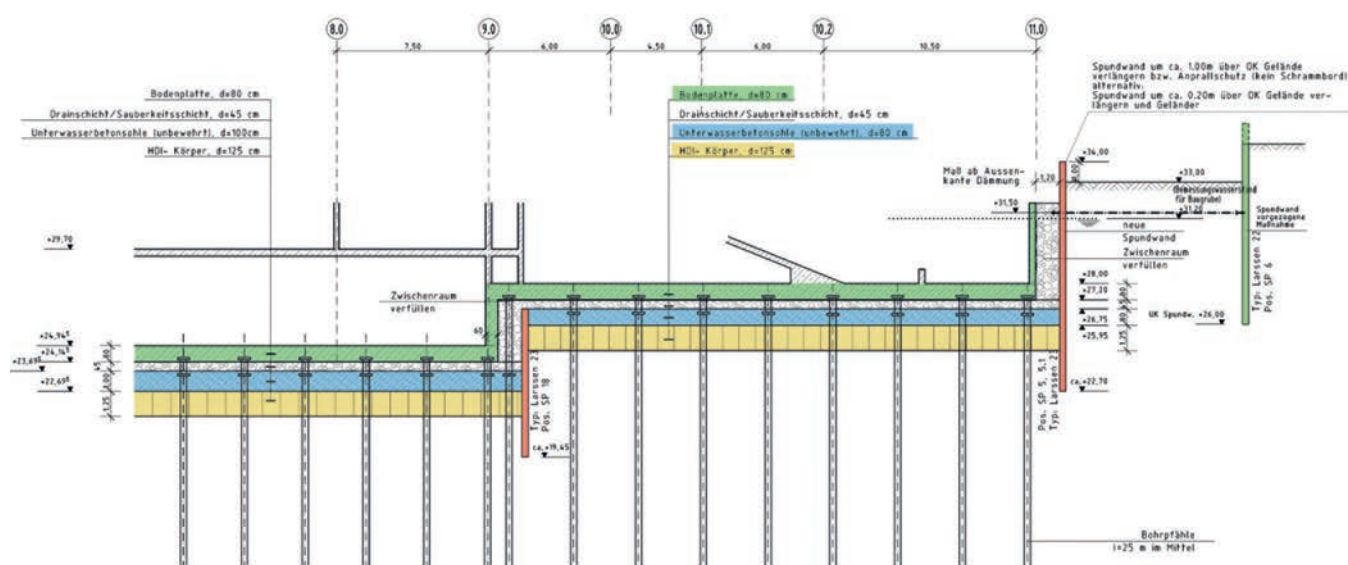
Schnitt durch die Baugrube mit Kleinbohrpfählen, DSV-Sohle, Unterwasserbetonsohle und tragender Bodenplatte
